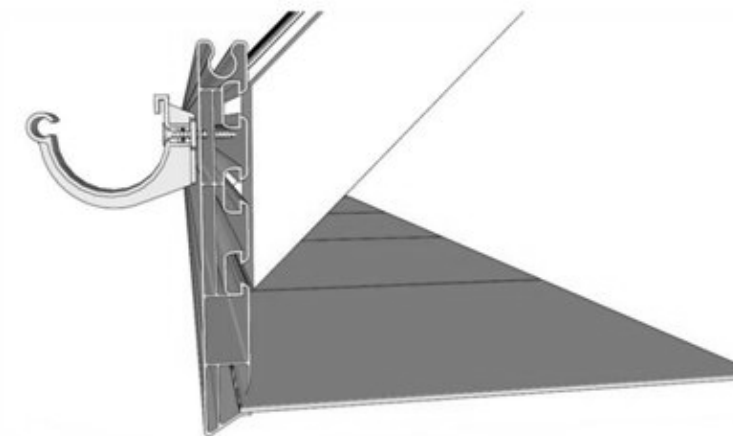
Principe de fixation du support de gouttière par vissage au travers du bandeau
